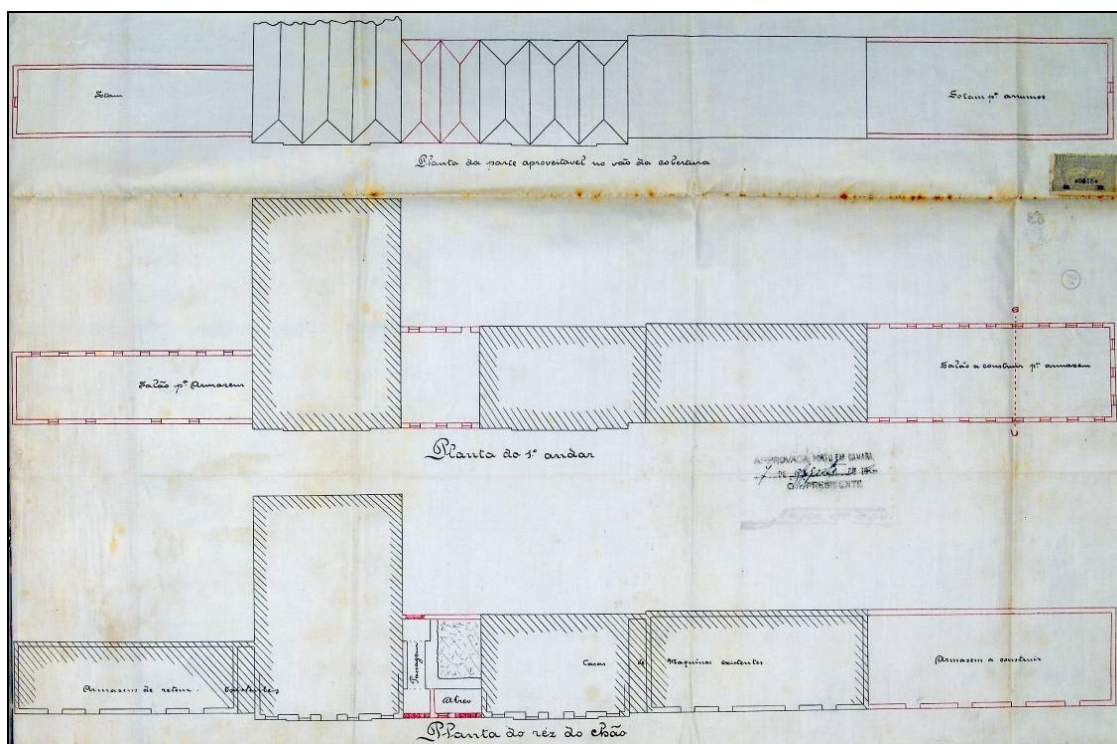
Planta dos armazéns projectados e respectivos pisos.
